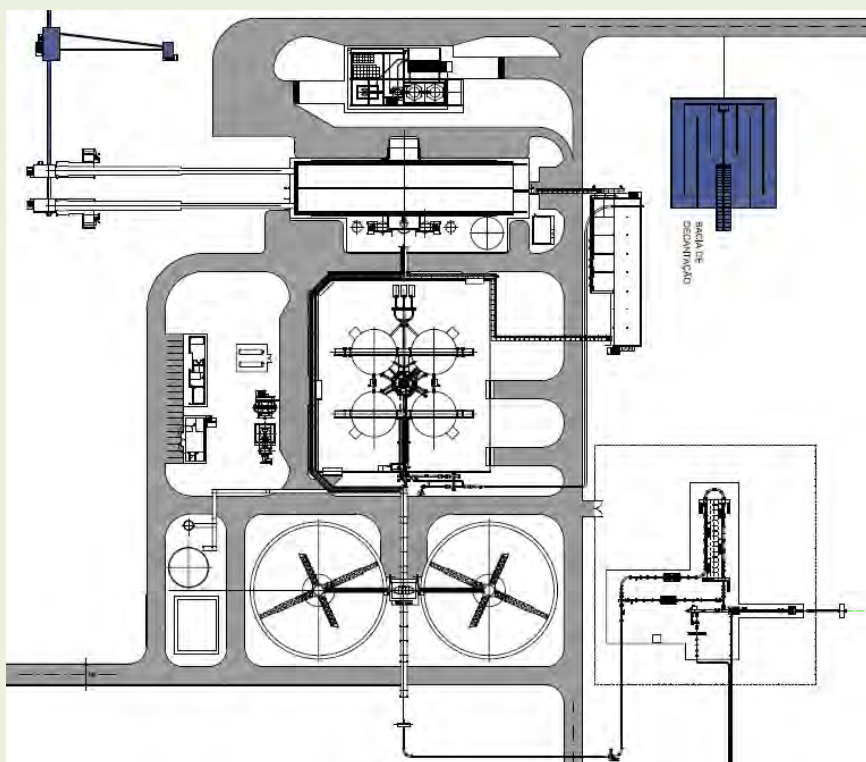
Planta de filtragem projetada para o Porto Norte Capixaba. Planta DEB08B010005C1 Anexo I.
